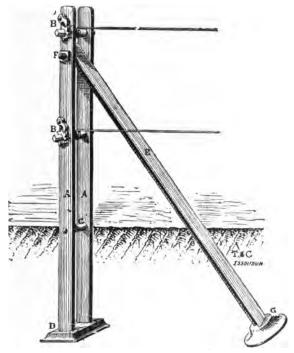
Poteau de tête de Taufflieb et Chaussard.
